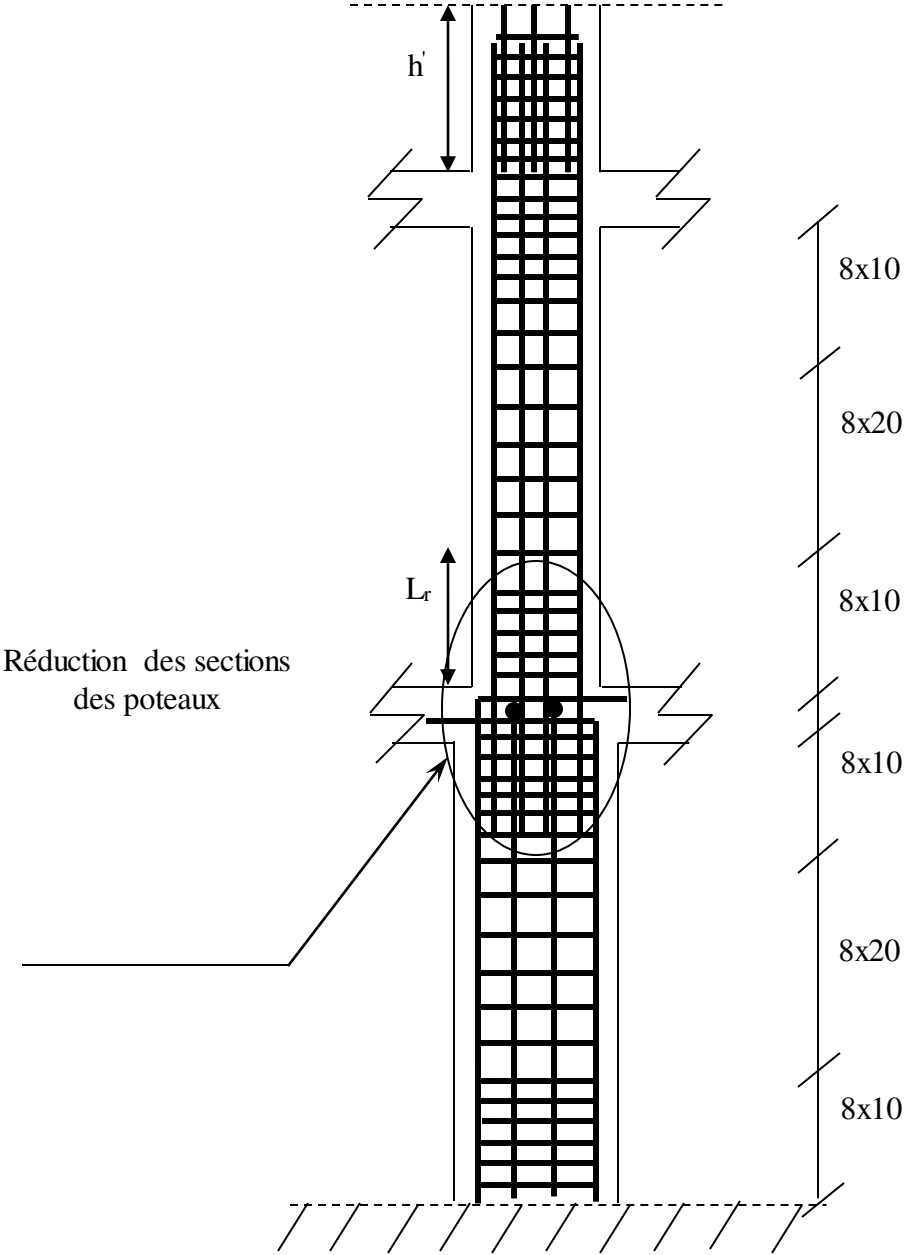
Disposition des armatures des poteaux (coupe longitudinale).
